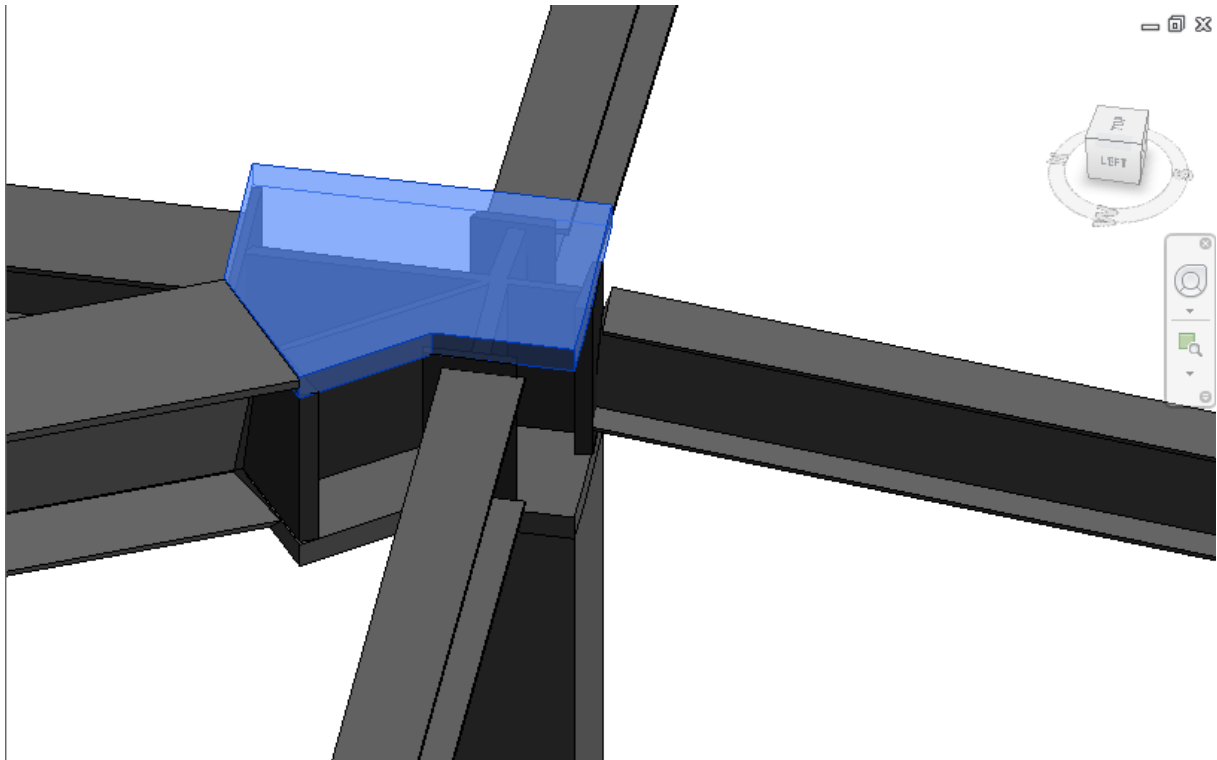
3ª Visualização tridimensional da ligação entre 5 vigas e um pilar
